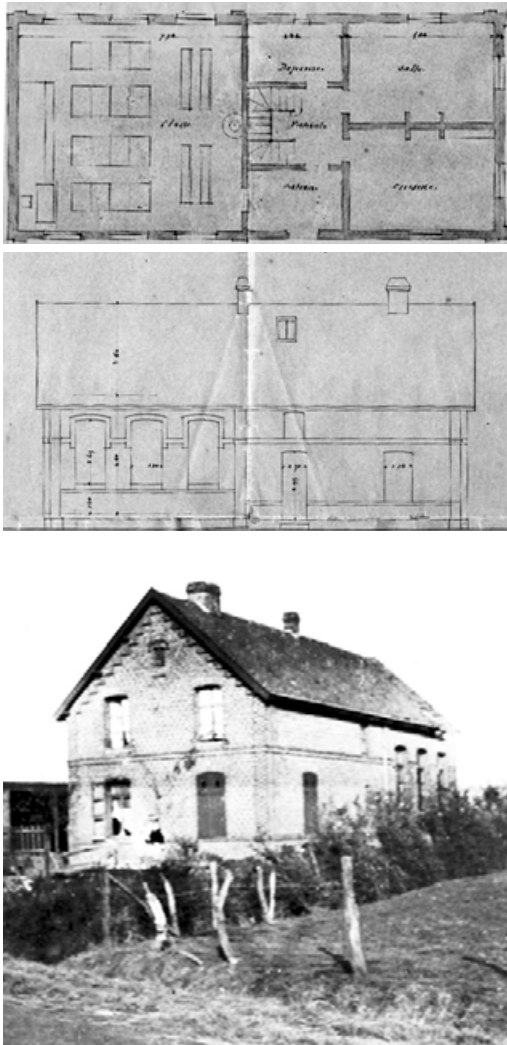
Plan et façade de l'école publique située dans le hameau de la Boutillerie construite en 1891, en haut ; une photographie de l'école avant sa destruction pendant la Première Guerre mondiale, en bas.
